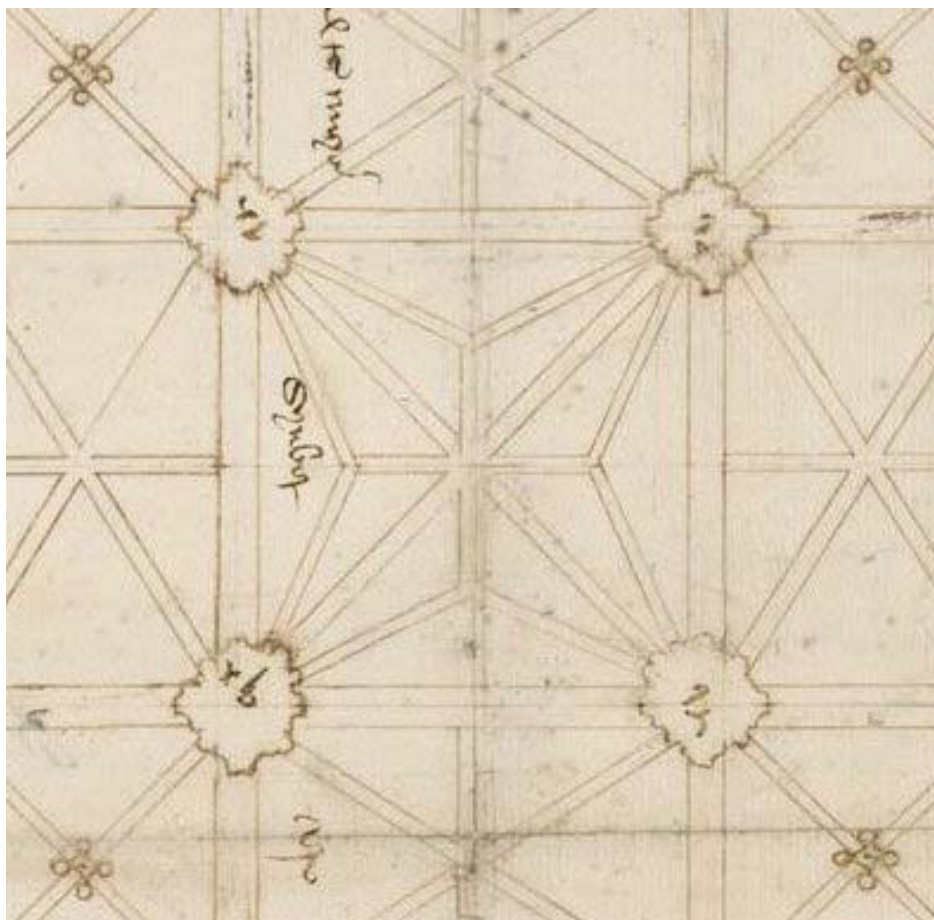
Plano de Bidaurreta. Detalle del cimborrio. (Alonso Ruiz y Jiménez Martín, 2009)
